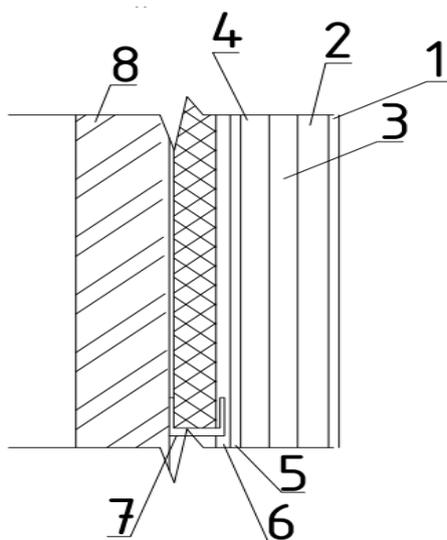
Схема мокрого фасада: 1 – краска; 2 – декоративная штукатурка; 3 – грунт; 4 – армирующая стеклосетка; 5 – клей для сетки; 6 – дюбель; 7 – утеплитель с опорным цокольным профилем; 8 – кирпичная стена [1]
